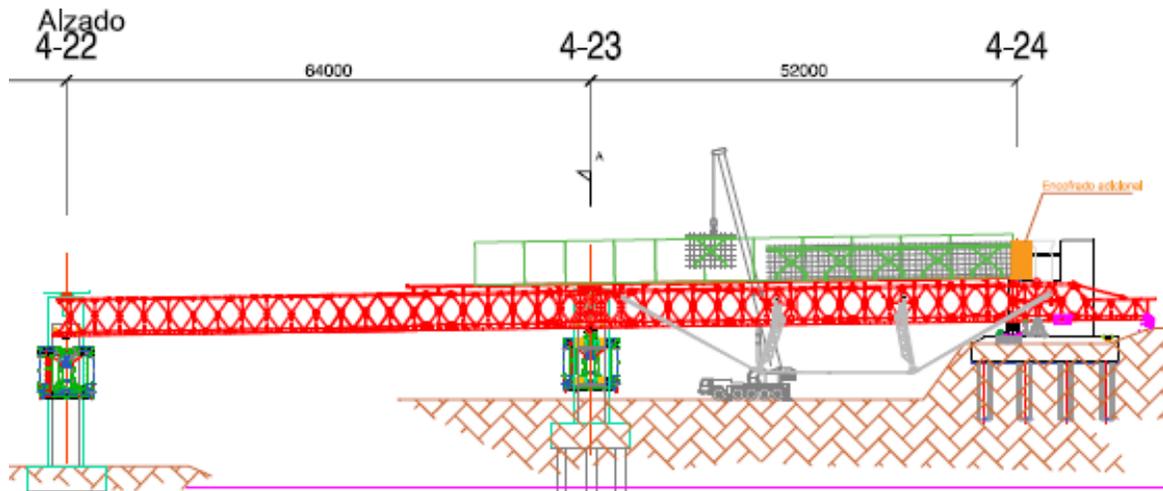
Colocación de armado de refuerzo sobre el encofrado externo
